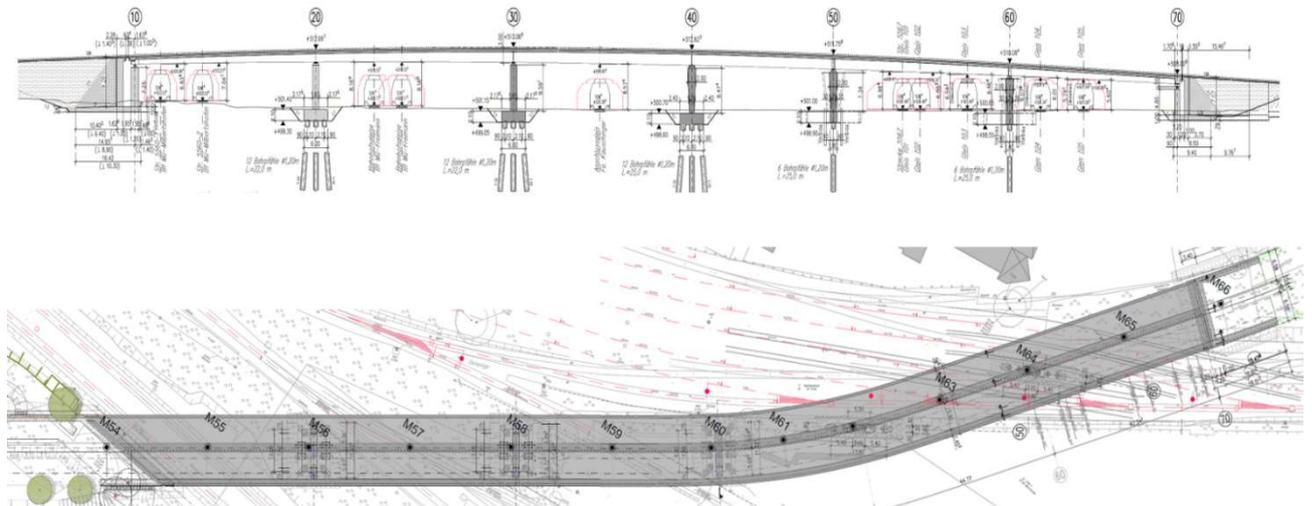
Längsschnitt und Lageplan der Brücke; Quelle: SWM/MVG, BPR Dr. Schäpertöns Consult
